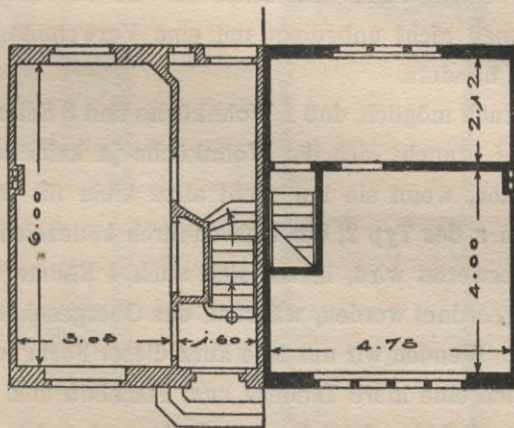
Typ 2b: Ausdehnung des einen Erdgeschoßraumes über die ganze Wohnfläche; oben zwei Stuben (Reihenhaus). Beispiel nach einem Hause der Gartenstadt Hellerau, nach dem Entwürfe von R. Riemerschmid.
